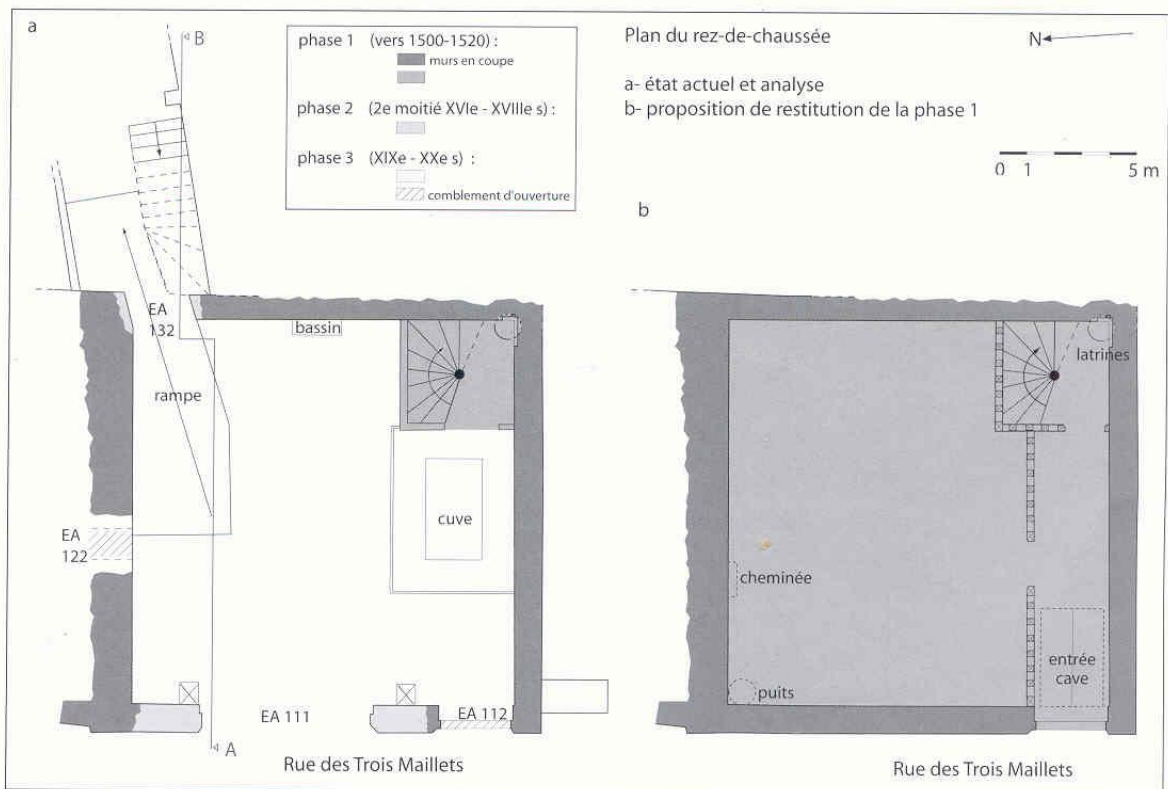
Orléans, Maison 4, rue des Trois-Maillets, rez-de-chaussée (relevé en plan et essai de restitution Cl. Alix et F. Chabrier).
